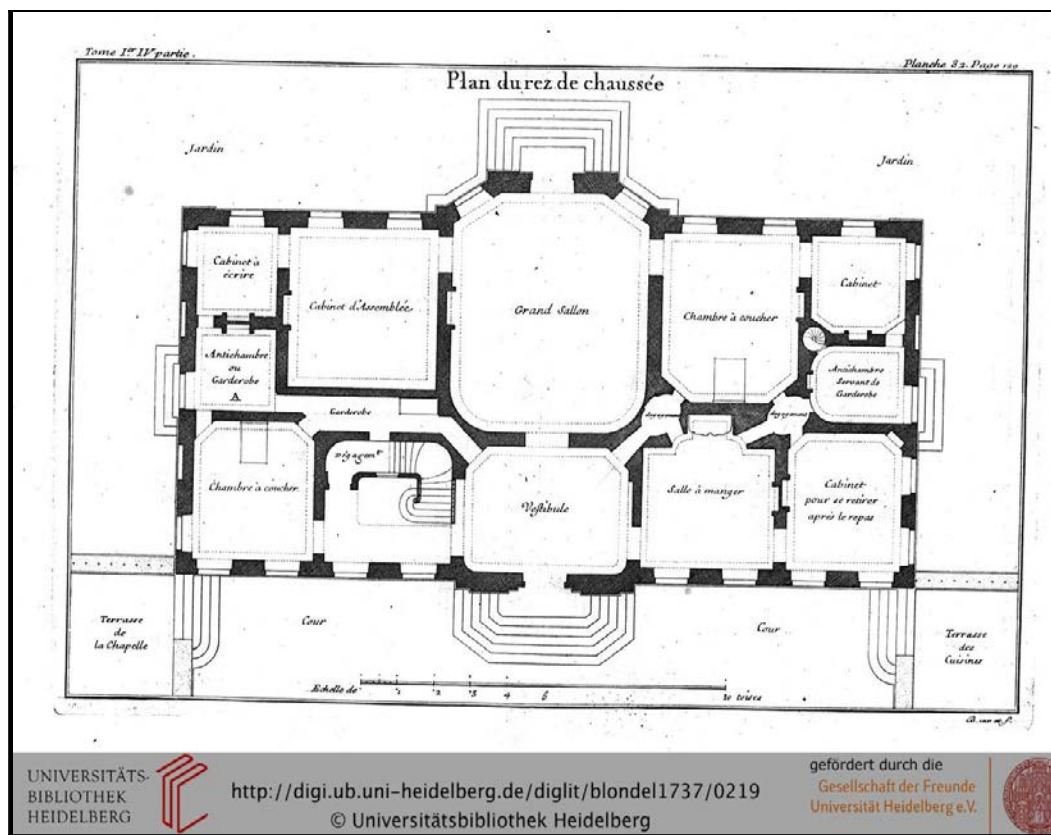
Jacques François Blondel, Grundrissentwurf des Erdgeschosses
